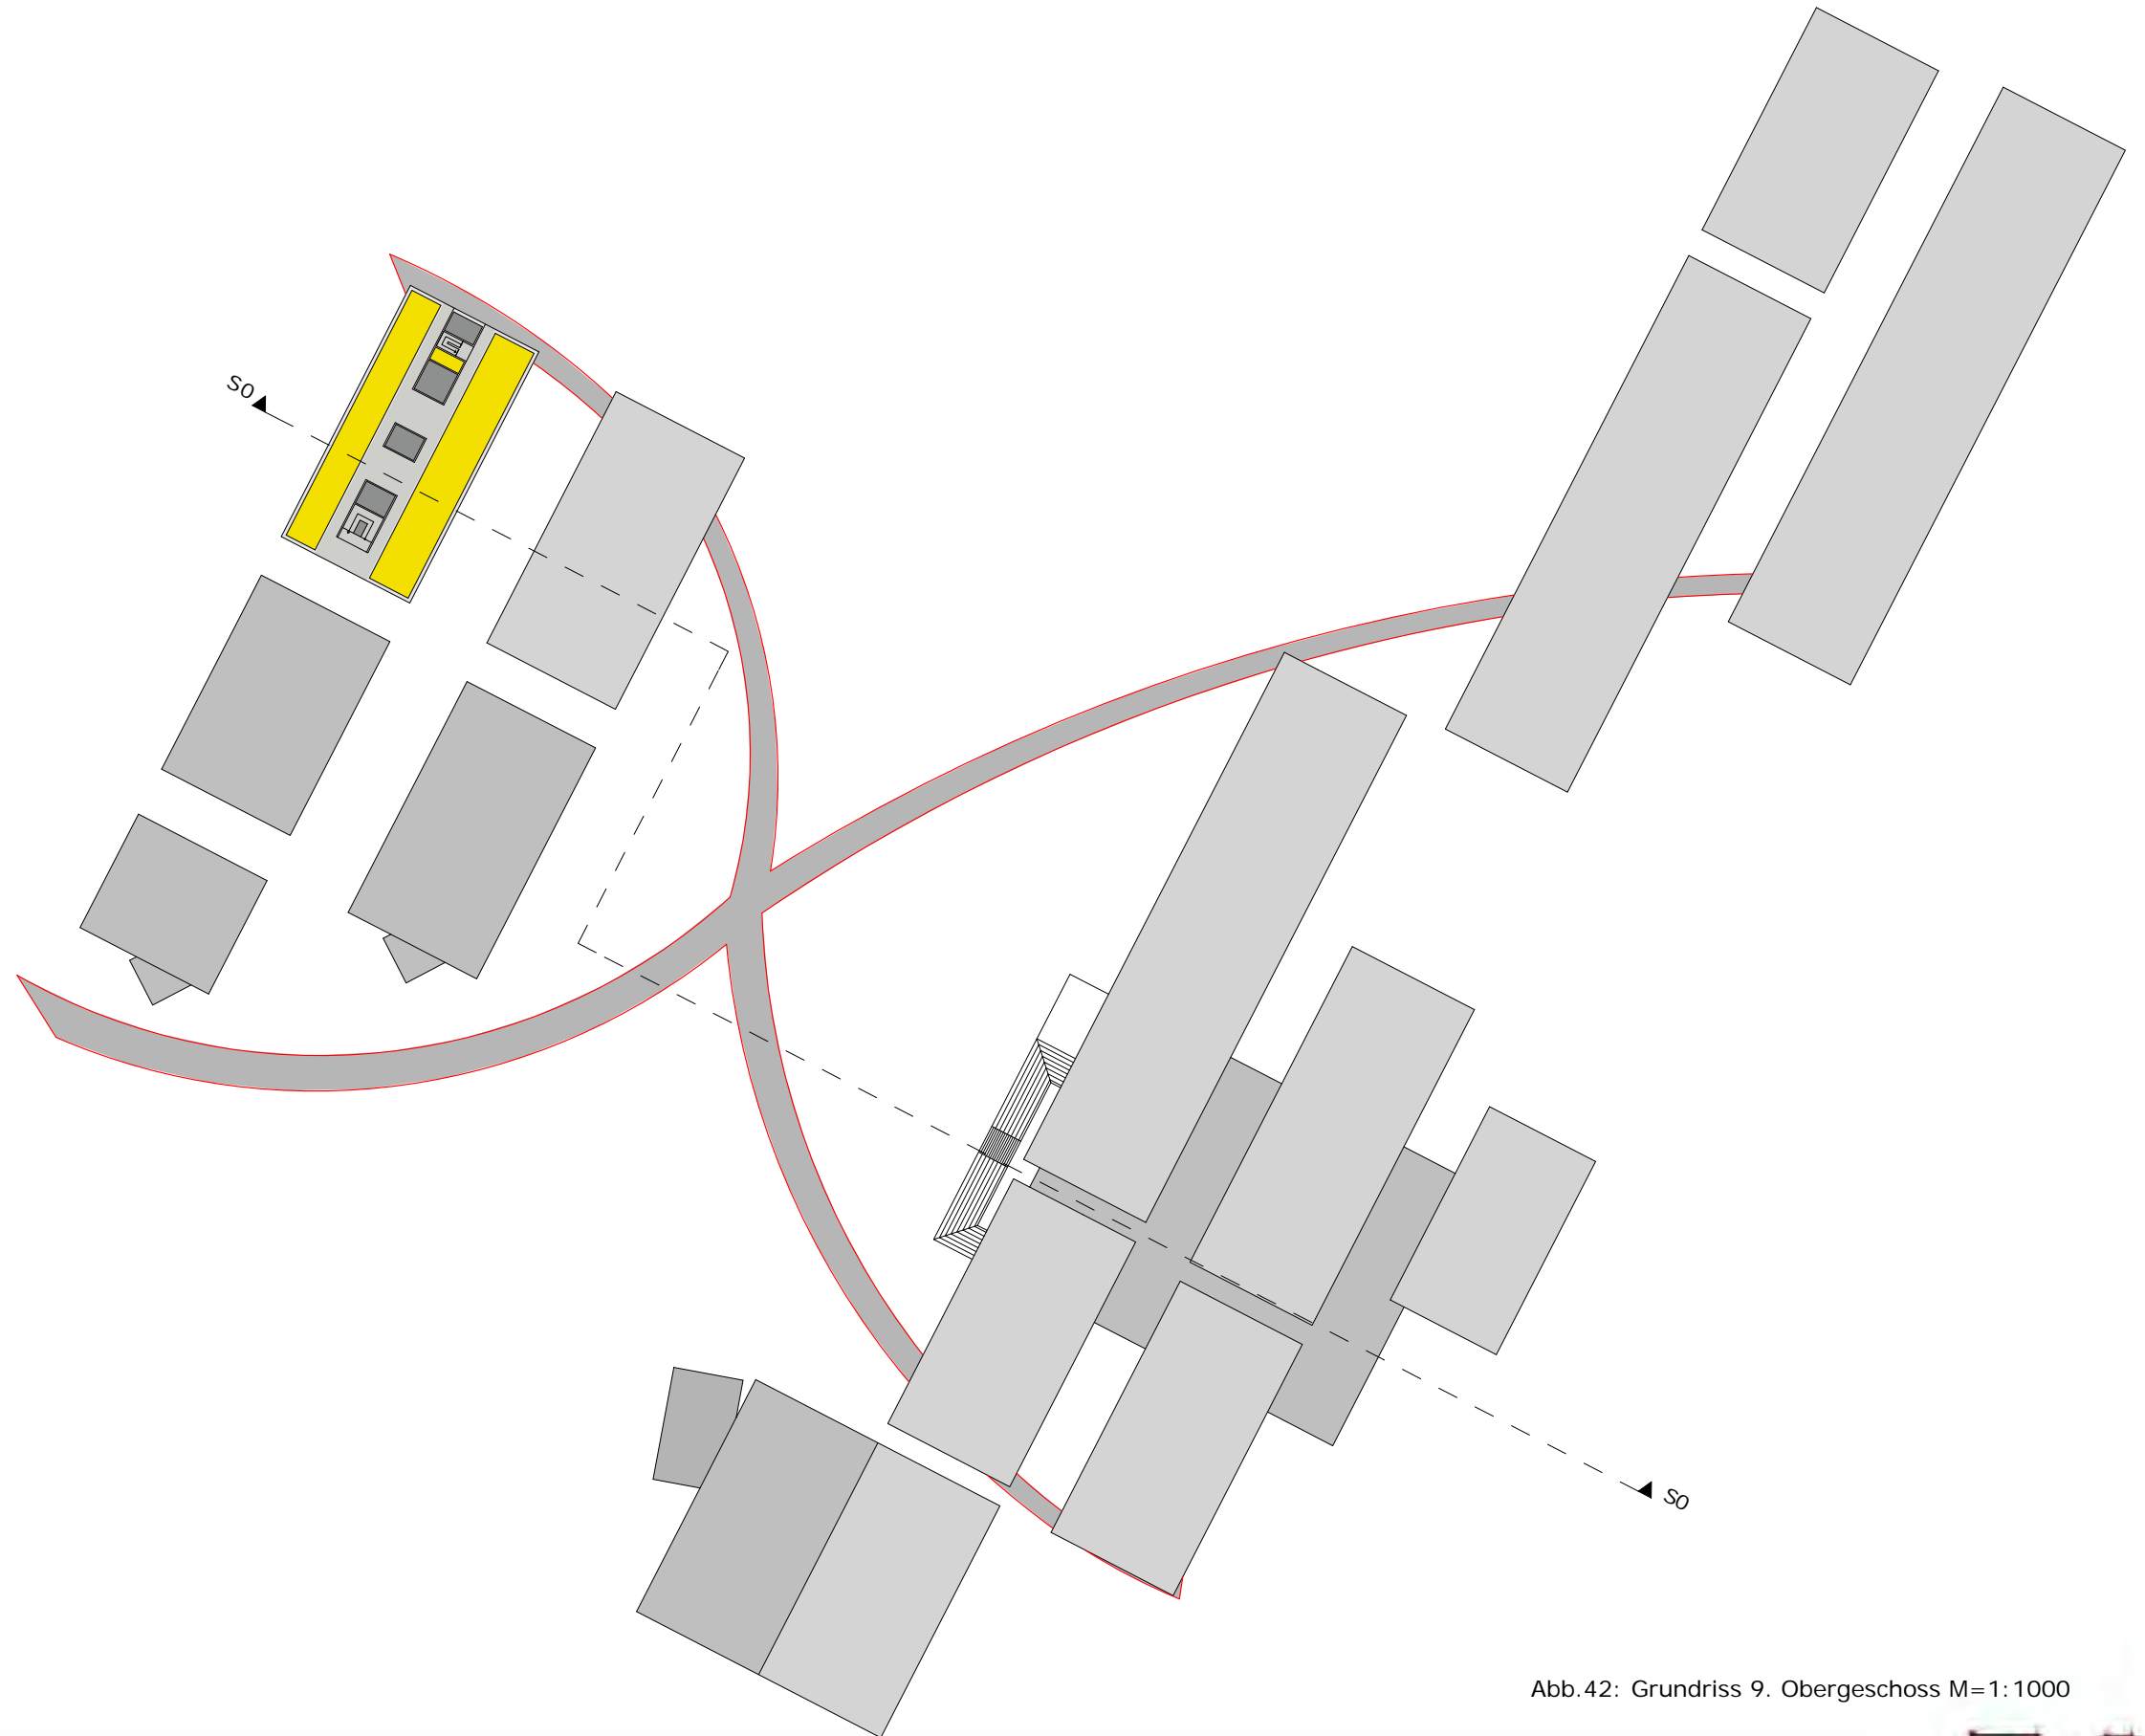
Grundriss 9. Obergeschoss M=1:1000
